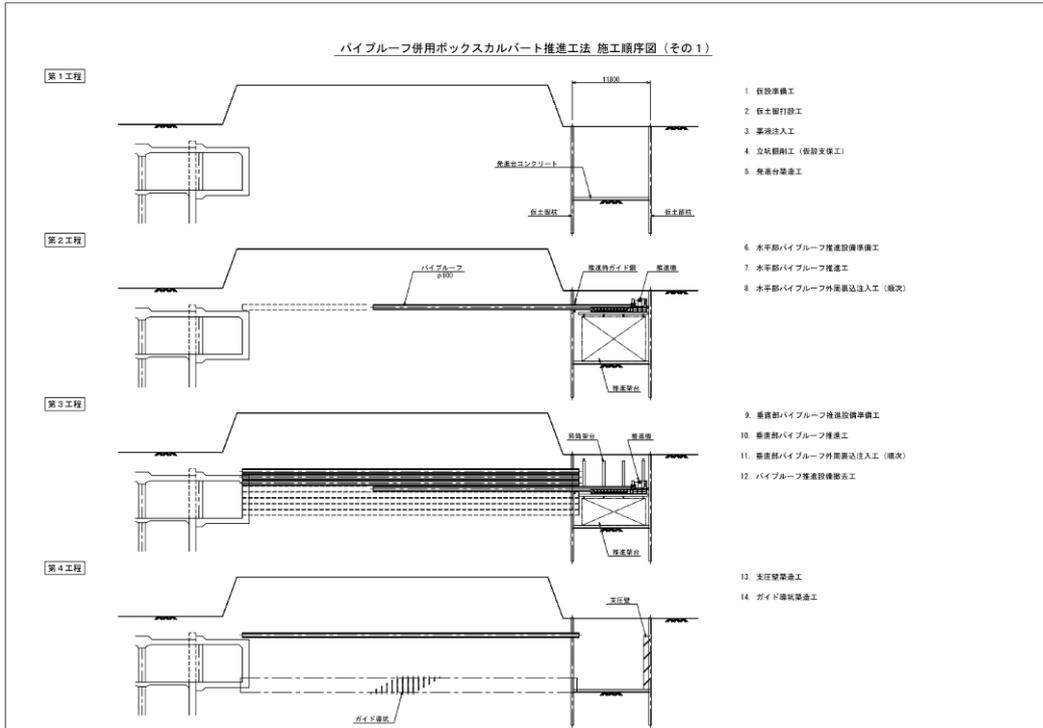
パイプルーフ併用ボックスカルバート推進工法施工手順図
